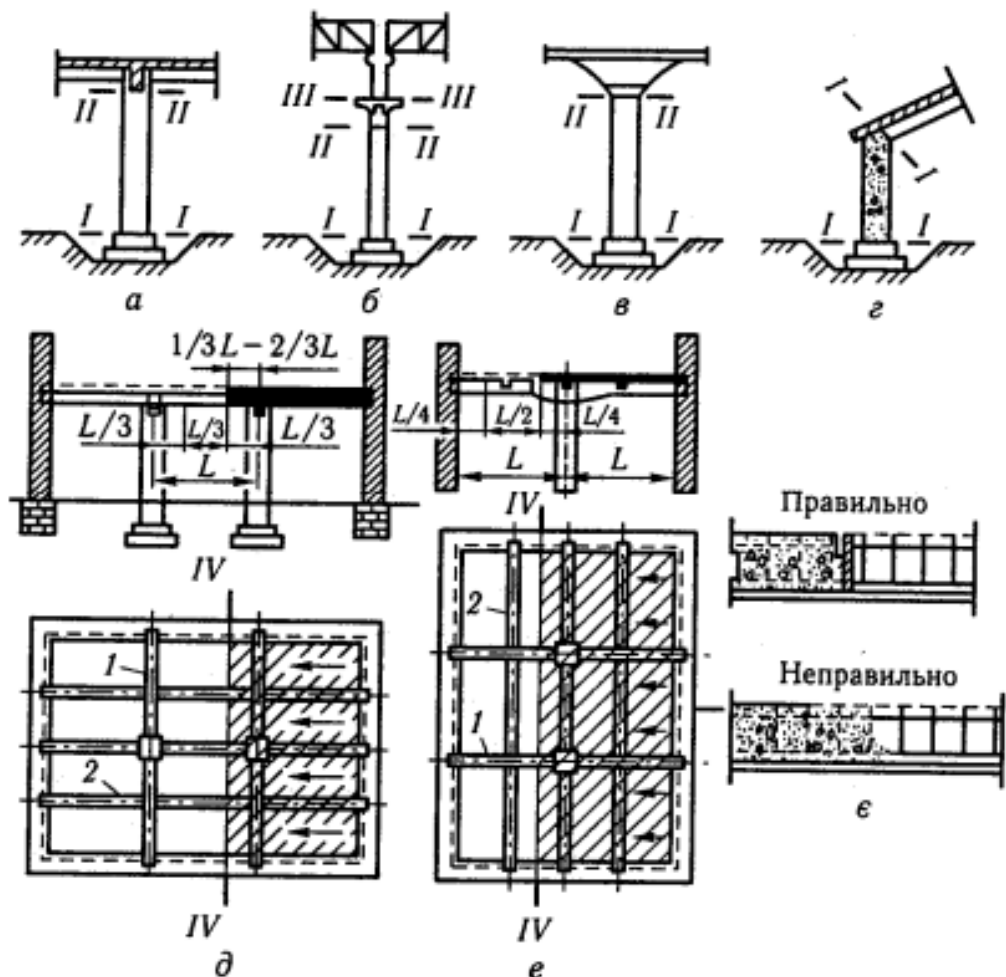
Розміщення робочих швів у процесі бетонування: а - колон і балок ребристого перекриття; б - колон з підкрановими балками; в - колон з безбалковим перекриттям; г - стояка і ригеля рами; д - ребристого перекриття в напрямку, паралельному балкам; е - те саме, в напрямку, паралельному прогонам; є
